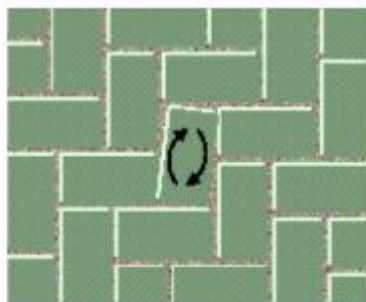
Movimento de giração dos Pavês (HALLACK, 1998).
